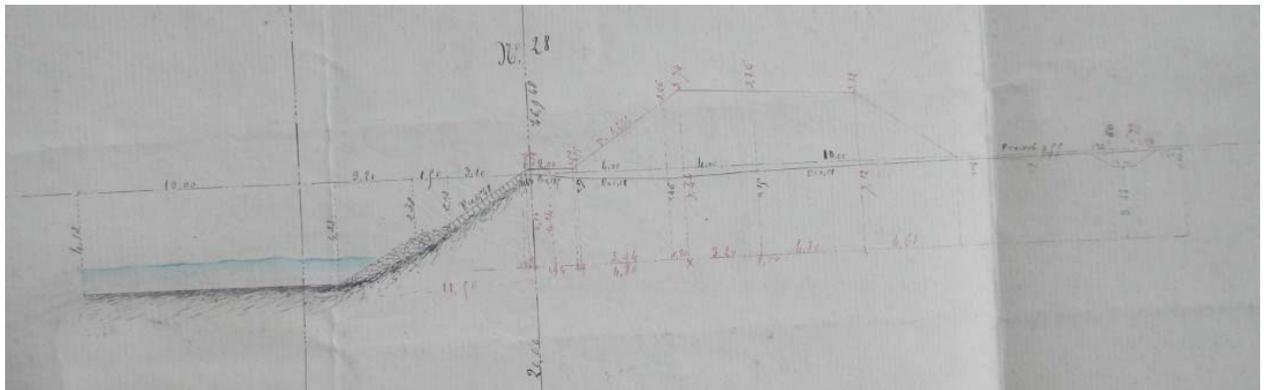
Profil type de la levée de la Jonction 3ème section avant et après exhaussement – Source : archives DDT 58
